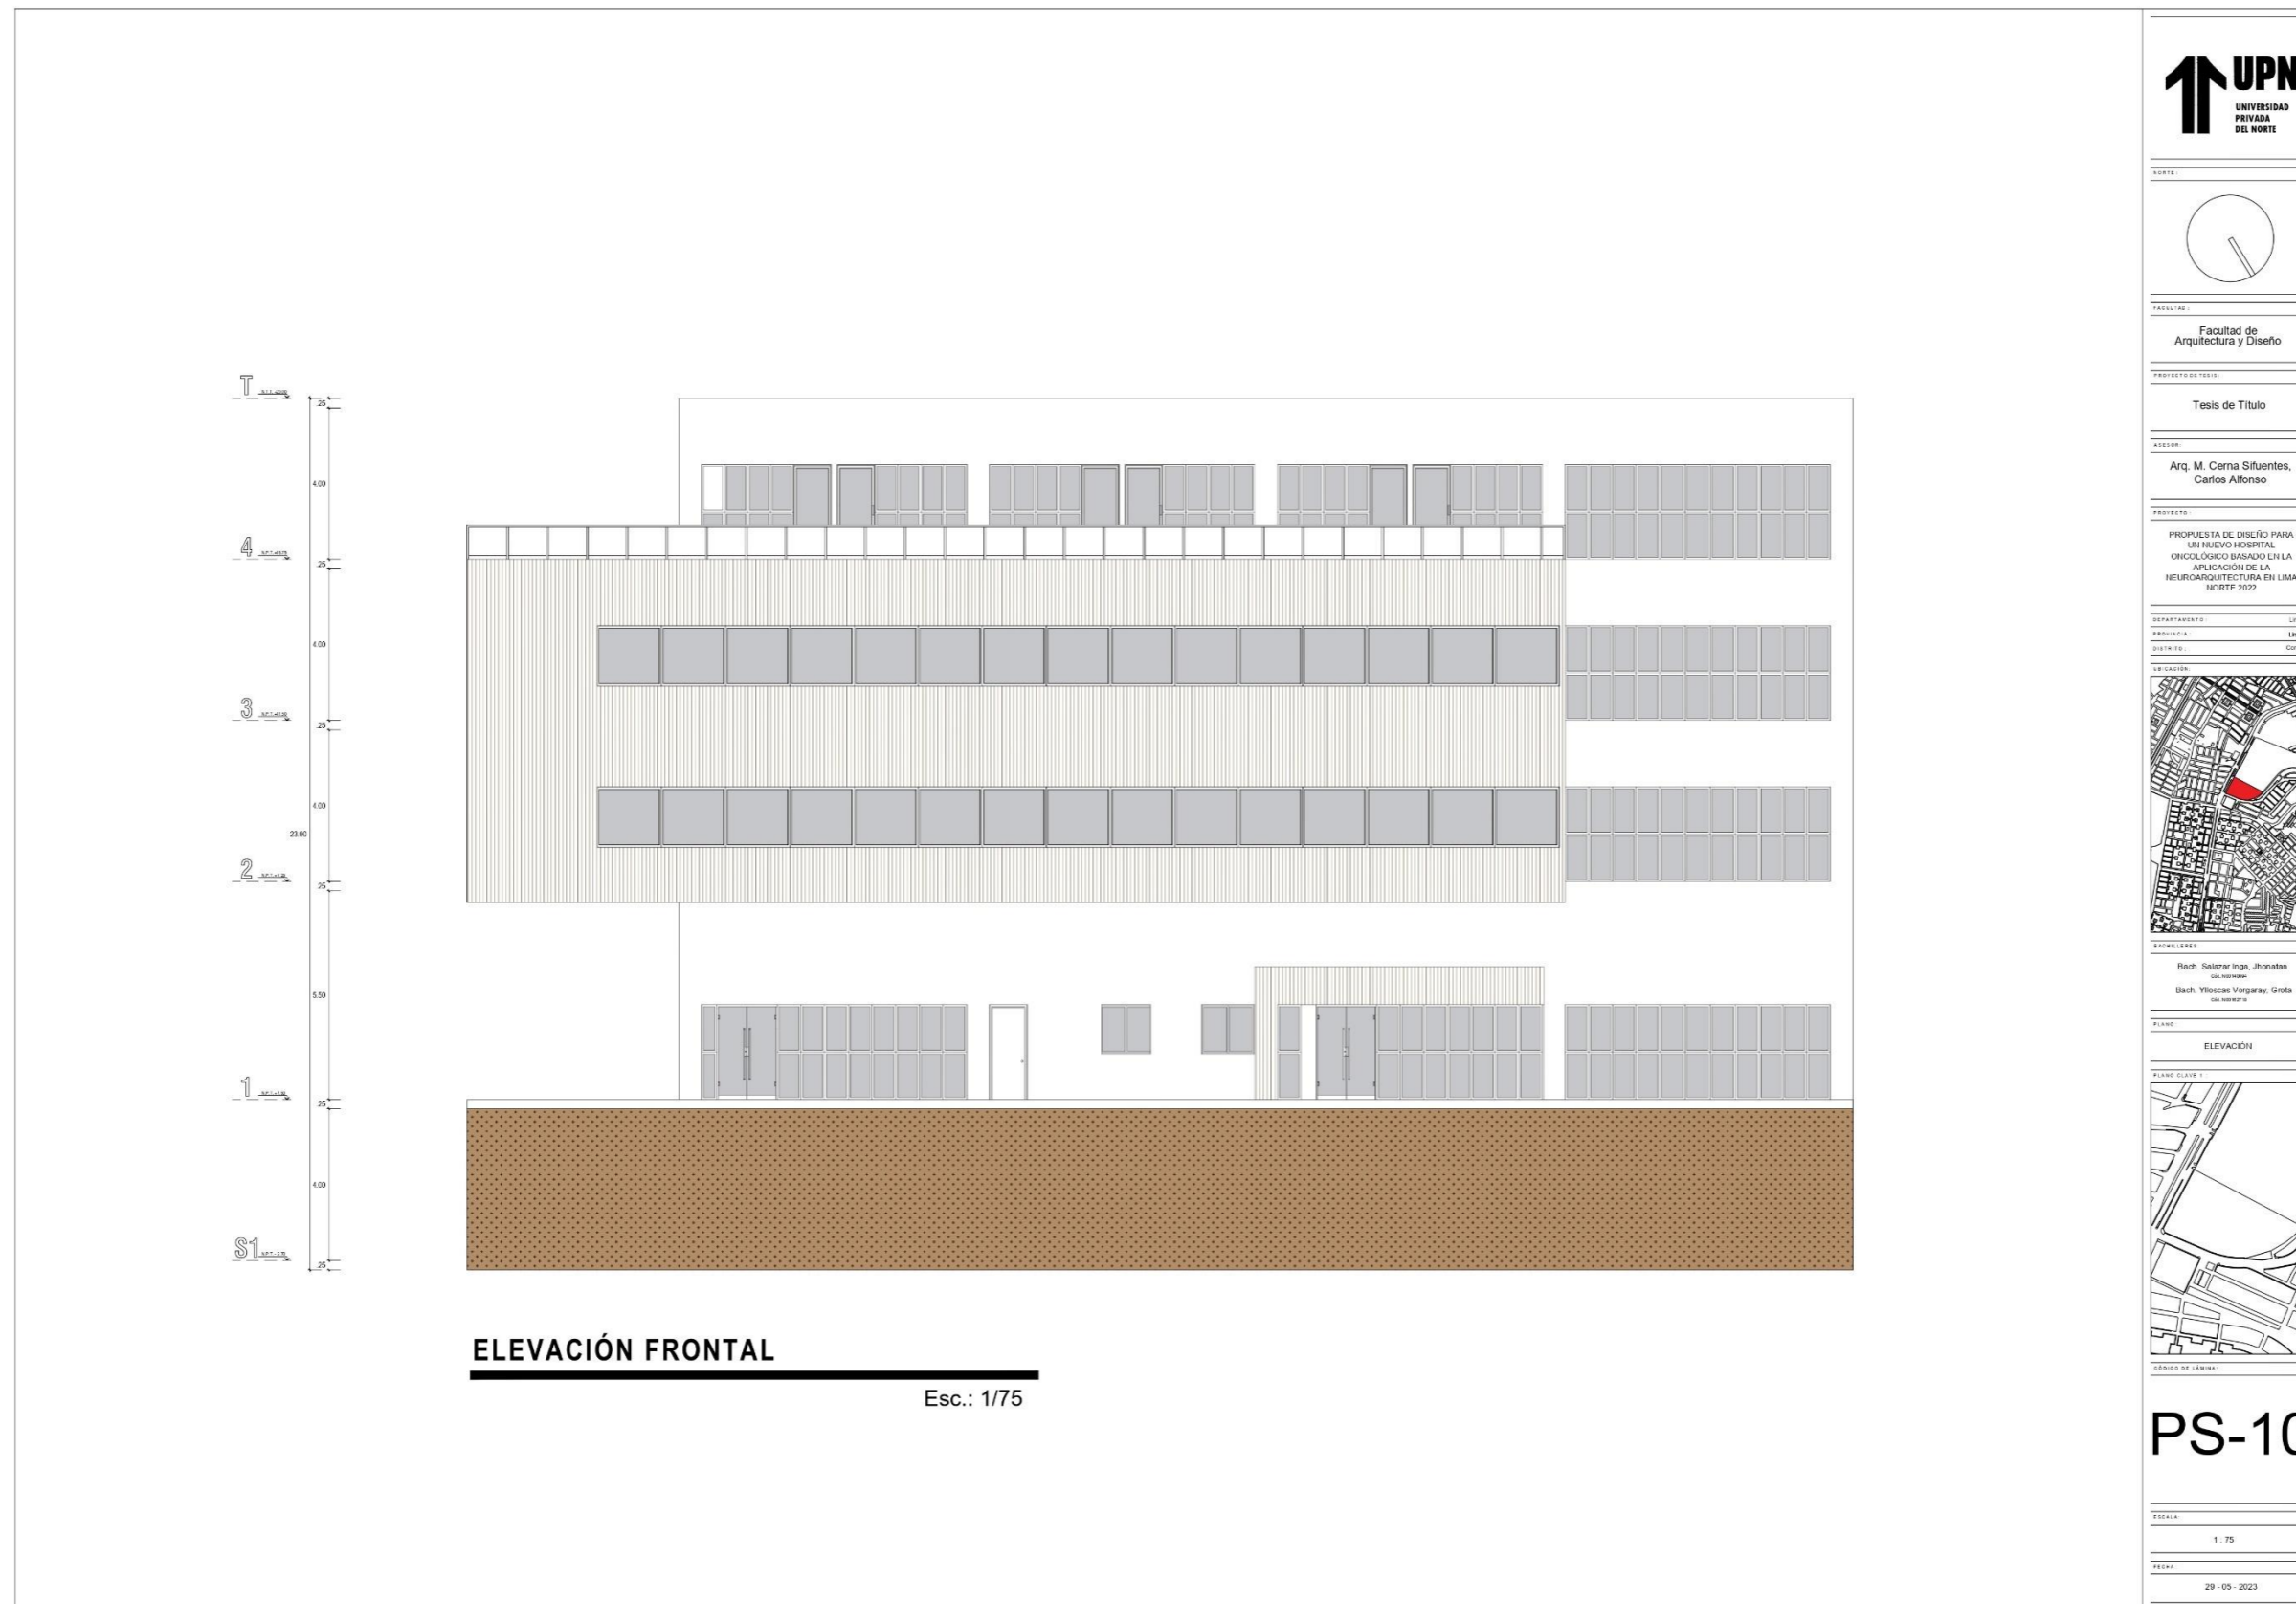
Arquitectura – Elevaciones N°1 del sector cuadrante Esc: 1/75 (Fuente: Elaboración propia de los coautores)
